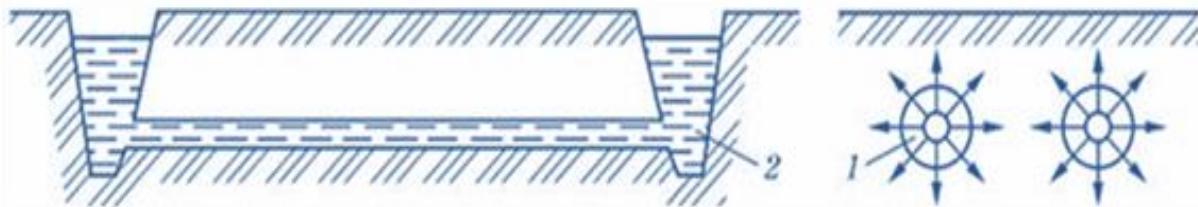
Схема підґрунтового зрошення: 1 – дренажні труби; 2 – кротовини
